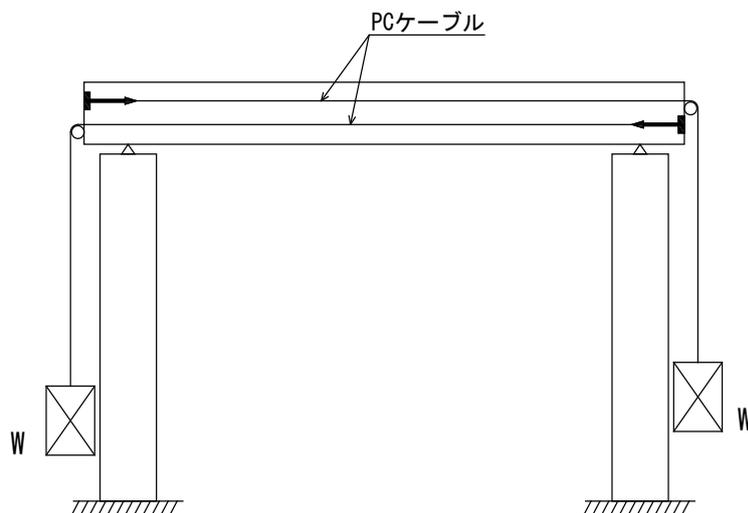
重力（万有引力） W による梁へのプレストレス力の導入
